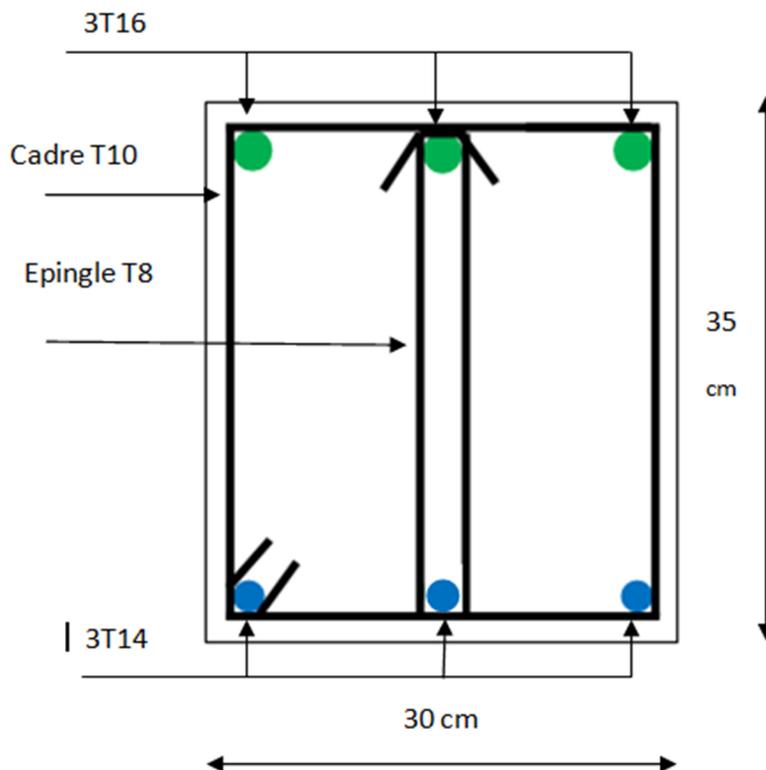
Schéma de ferrailage d'une poutre secondaire en appui
